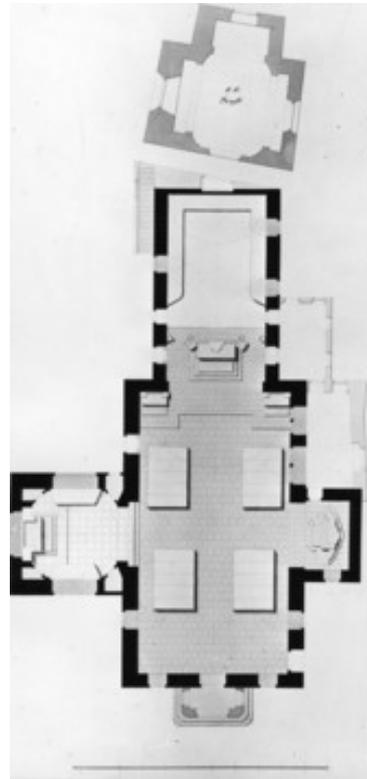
Alter Bauplan der Lage der ersten Loretokapelle
